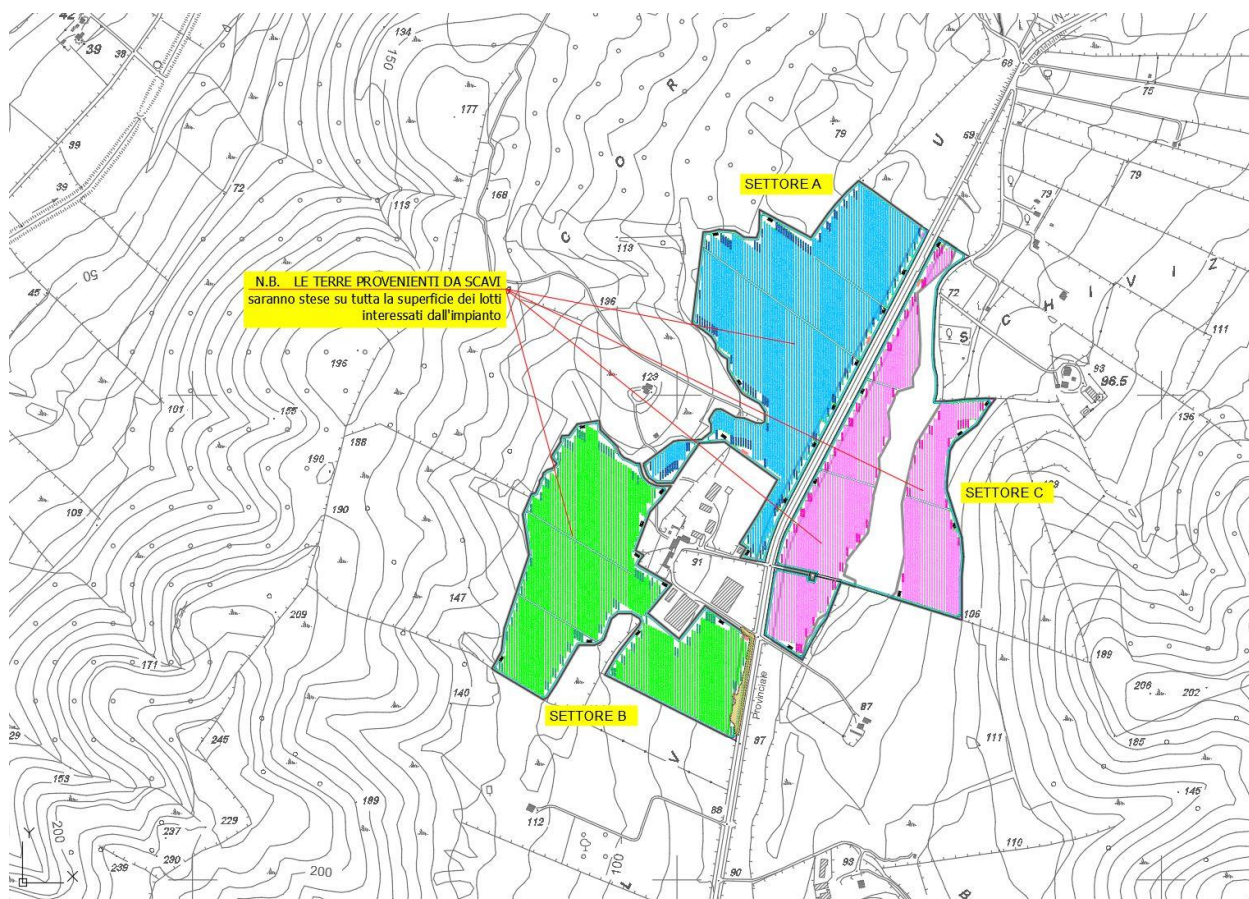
Planimetria individuazione area spandimento terre da scavo
